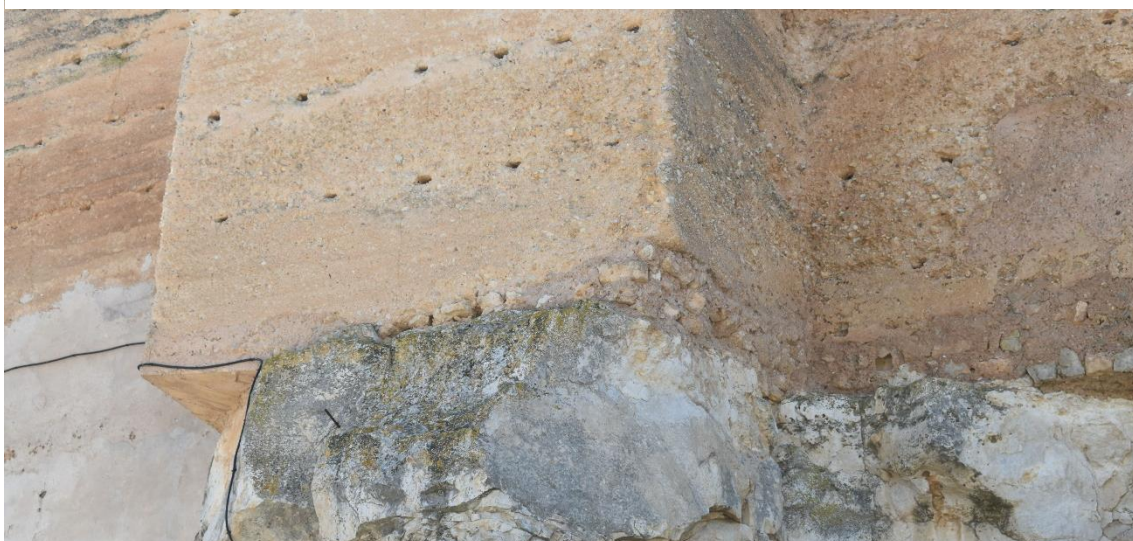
Detalle 1.8. Recalce cimentación de Hormigón de cal, piedra y arena parda torre D.
